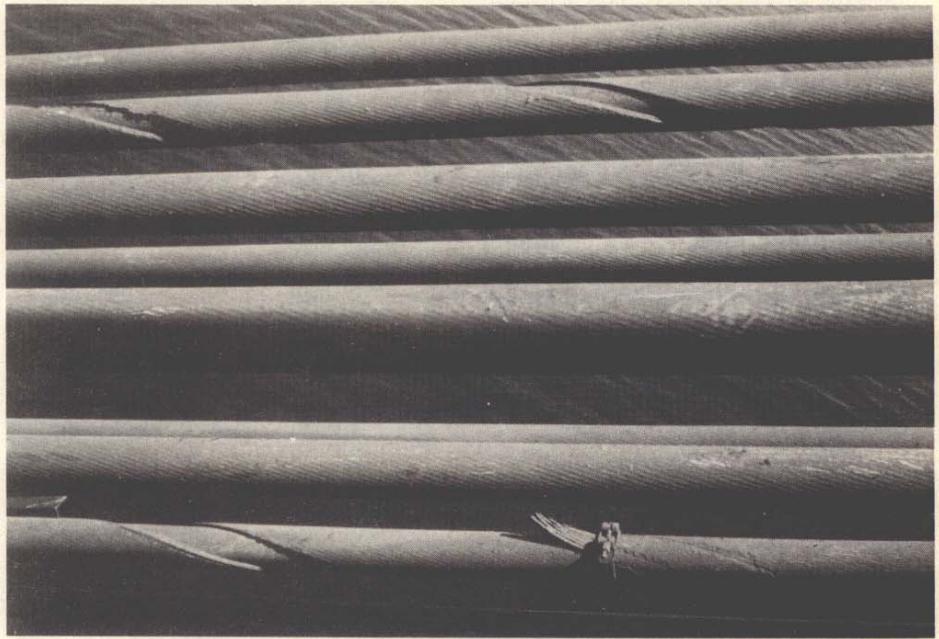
Puente Maracaibo. Cable cerrado con hilos rotos en la capa externa.
